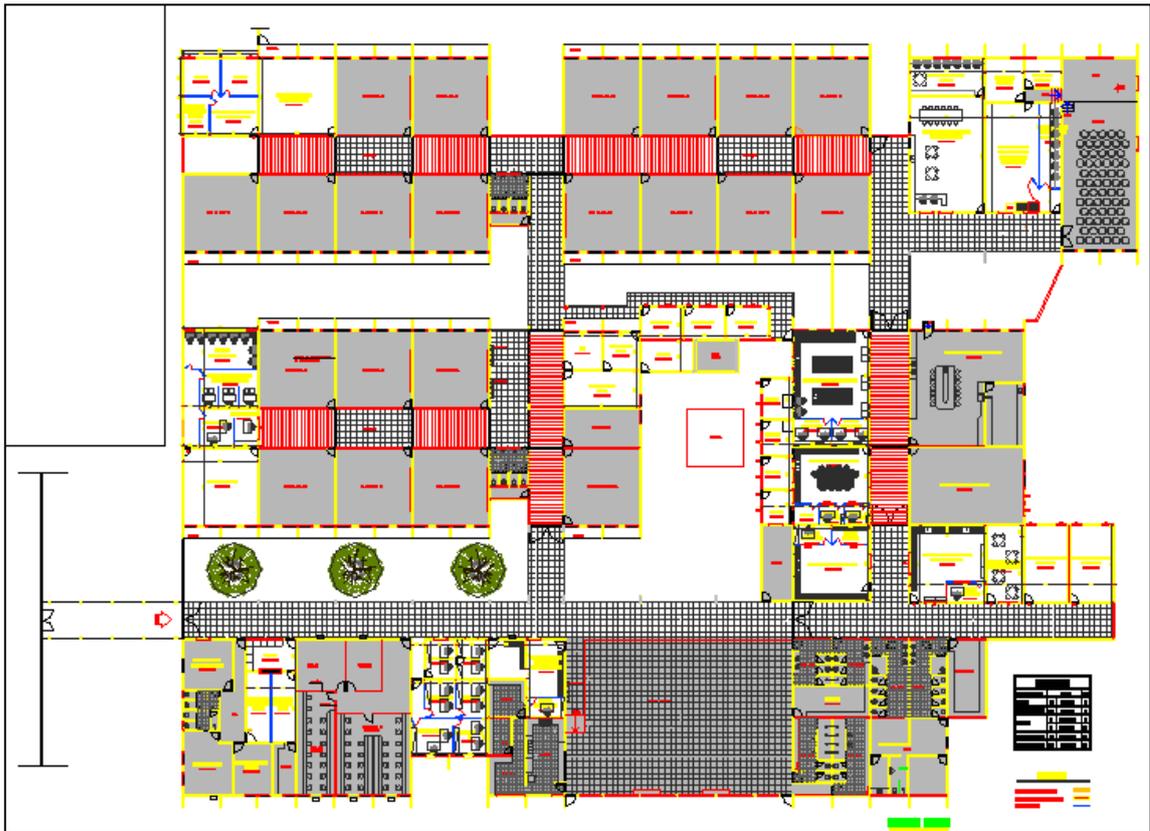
Planta baixa fornecida para a realização do projeto elétrico João Pessoa
